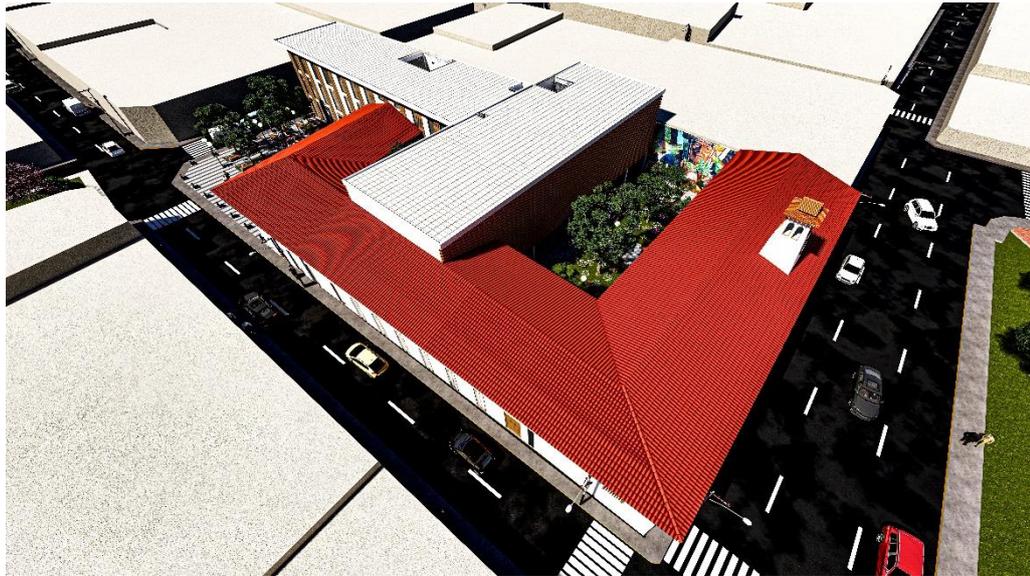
Vista aérea intersección Jr. San Román y Jr. San Martín
